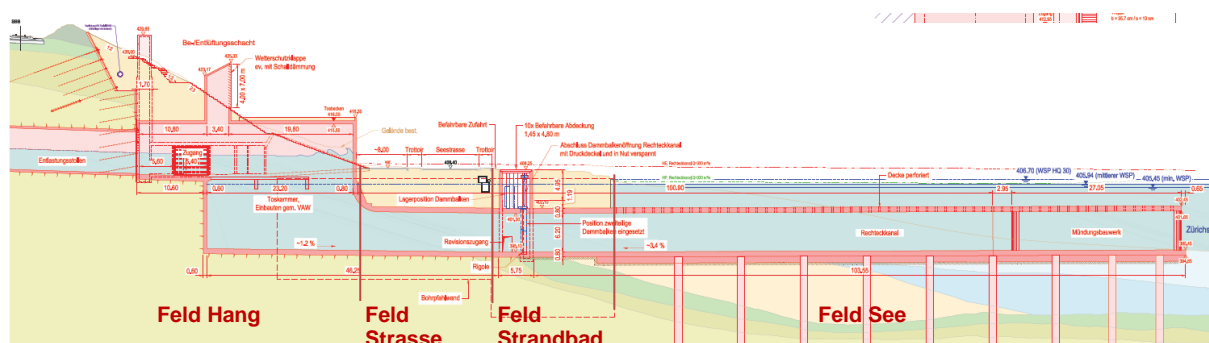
Längsschnitt durch das Auslaufbauwerk
